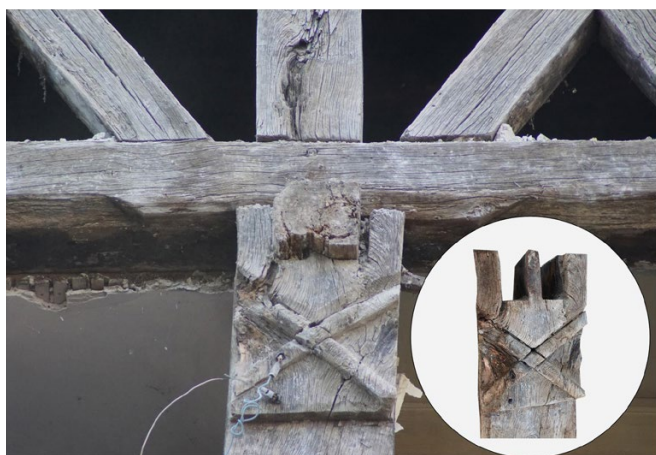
Buschwiller, 16 rue de Wentzwiller. Haut de poteau central sur pignon taillé en console, portant une croix en X. Assemblage de la sous-poutre longitudinale.
